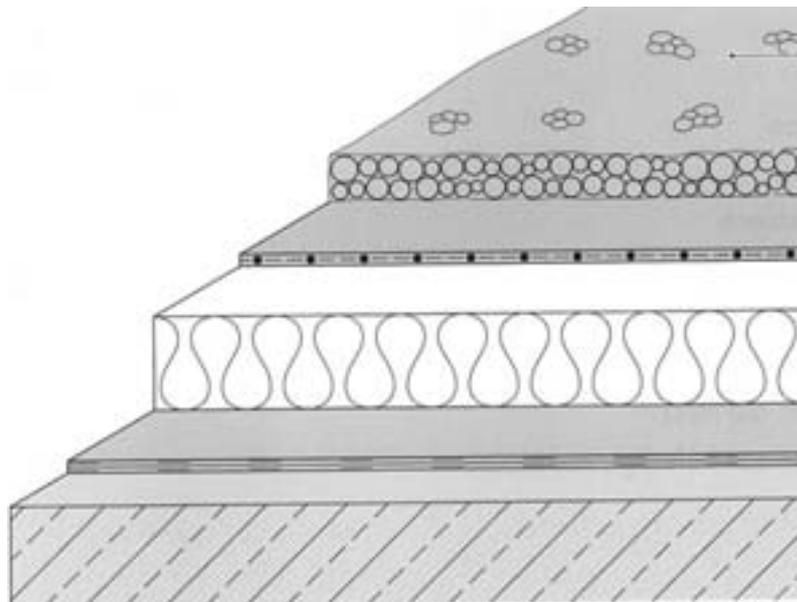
Schematische Darstellung des Warmdaches: einschalige, wärmegeämmte und nicht durchlüftete Flachbedachung, bei der die Abdichtung über der wärmedämmenden Schicht liegt
